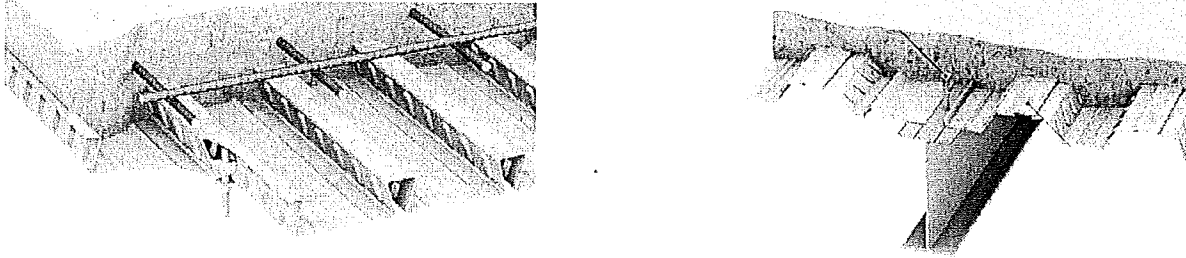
Detalles ilustrativos de sistema constructivo losa-acero.
